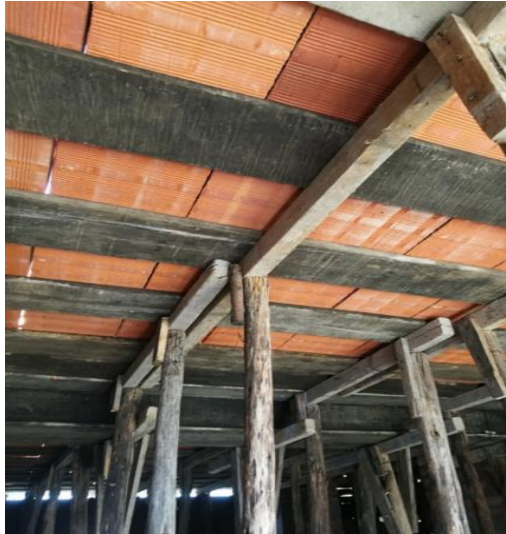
Viguetas encofradas el 10mo día de haber sido vaciadas SC-01
